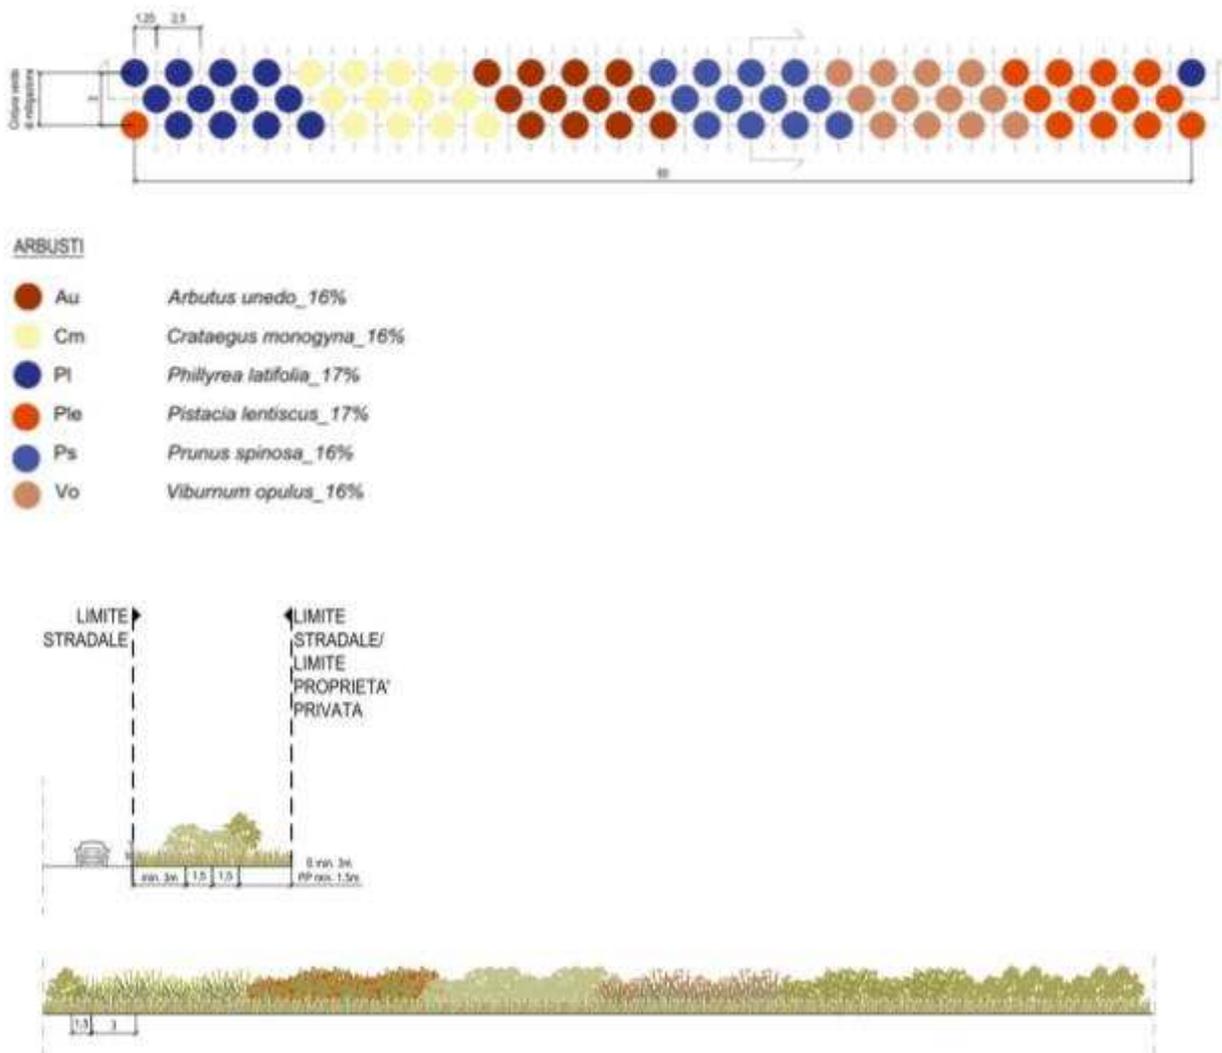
Sesto d'impianto e sezione tipologica PA1
